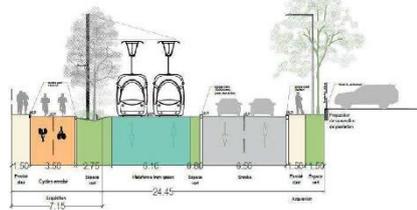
COUPE PROJET AU DROIT DU BOULEVARD LUCIEN SAMPAIX
